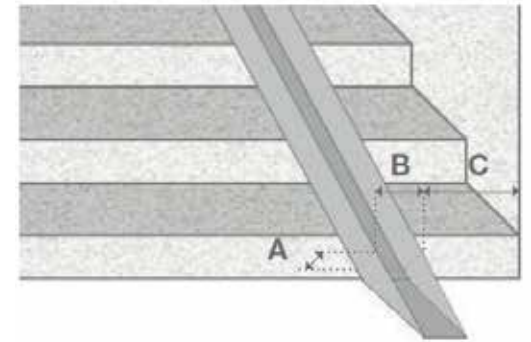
| U Şeklinde Beton Bisiklet Merdiven Kanalı
